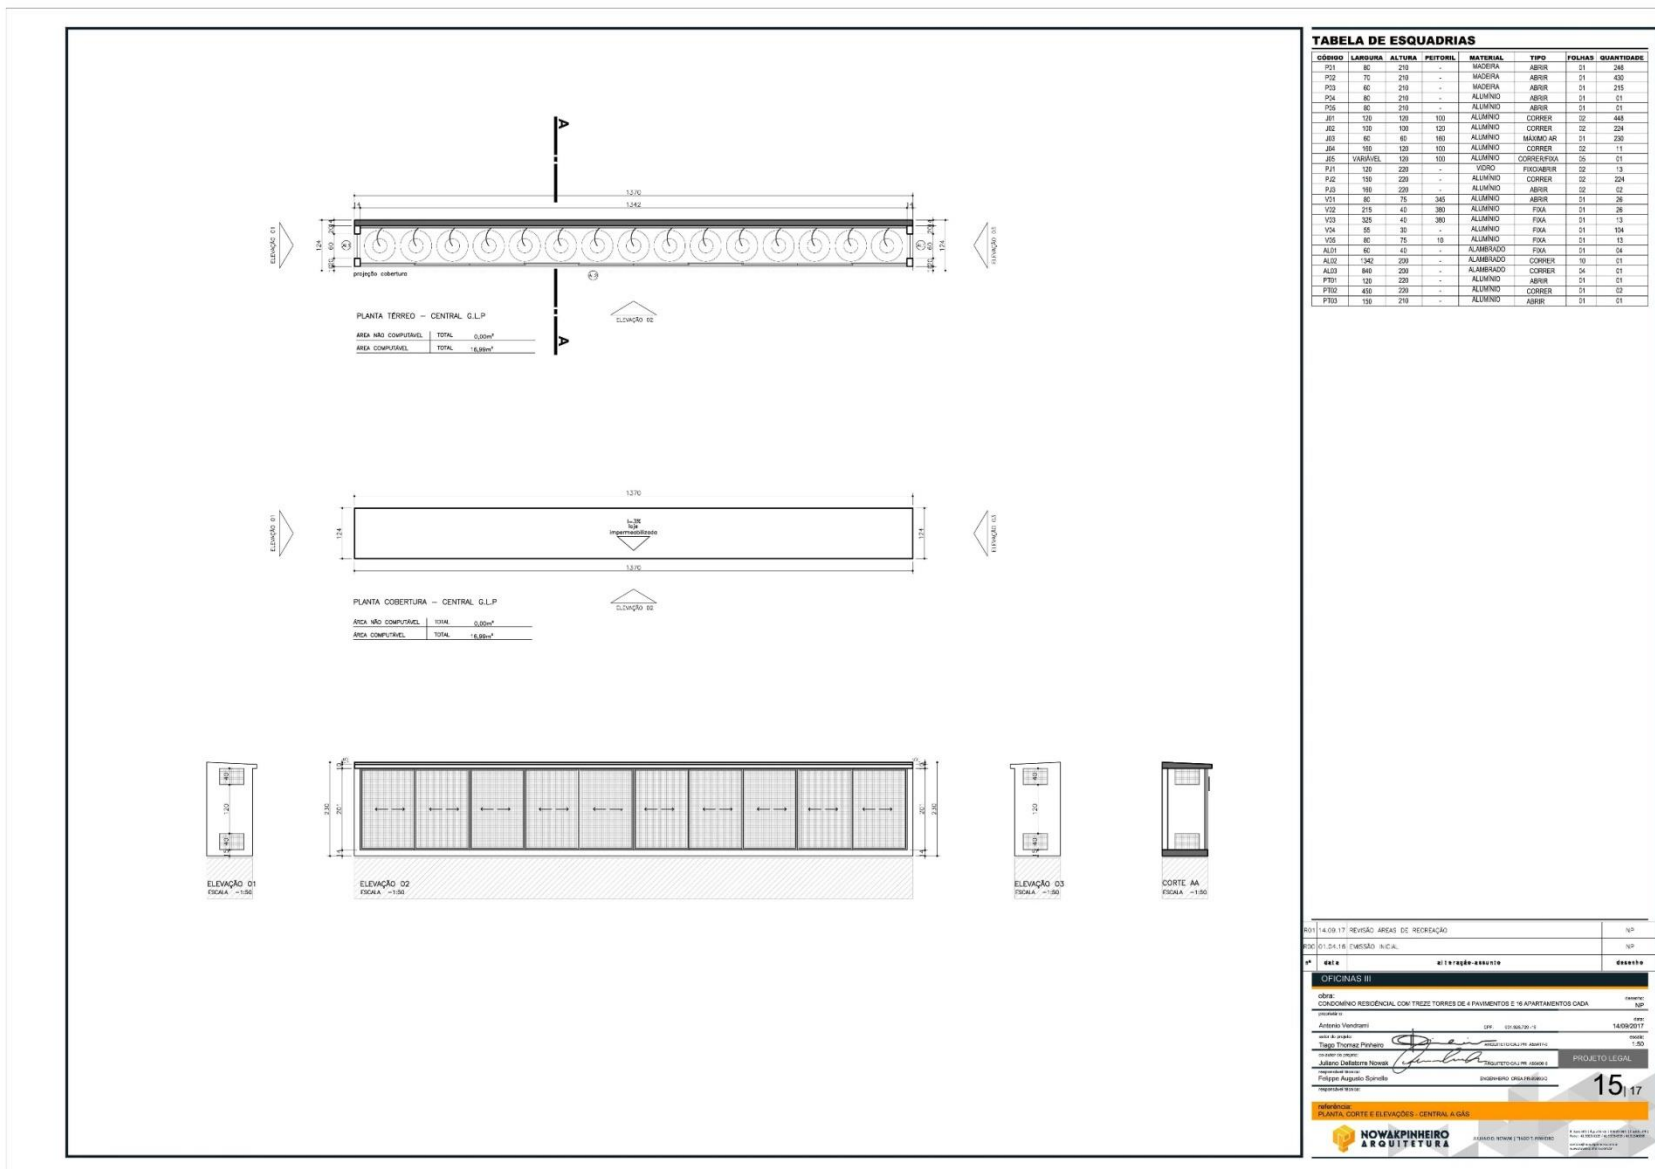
Planta baixa, cobertura e elevação da central de GLP.
